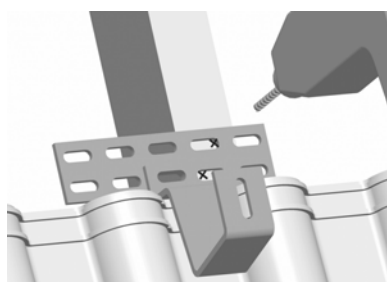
Sparrenanker für Frankfurter Pfanne und ähnliche Dachsteine
